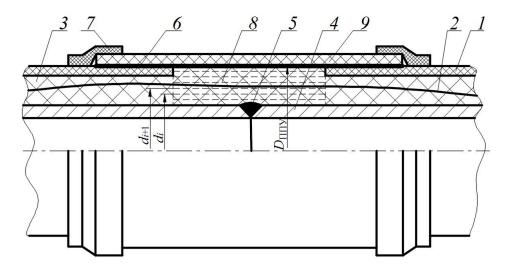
Альтернативная теплогидроизоляция стыка: 1 – оболочка полиэтиленовая; 2 – провод СОДК; 3 – ППУ трубы; 4 – труба стальная; 5 – шов сварной; 6 – адгезивная лента; 7 – манжета термоусаживаемая; 8 – напыленный послойно ППУ стыка; 9 – муфта термоусаживаемая; d_i , d_{i+1} – диаметр напыленного слоя и диаметр напыляемого слоя; $D_{\Pi\Pi Y}$ – диаметр наружной поверхности ППУ стыка
